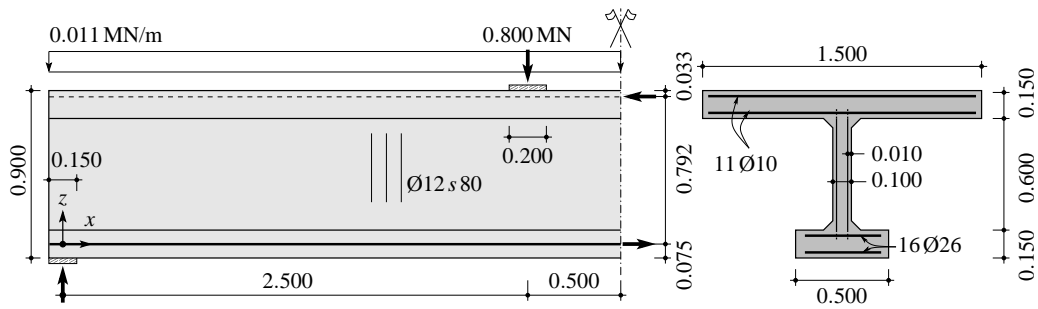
Abmessungen, Bewehrung und Bruchlast des Versuchsträgers T1 von Leonhardt und Walther [94]
